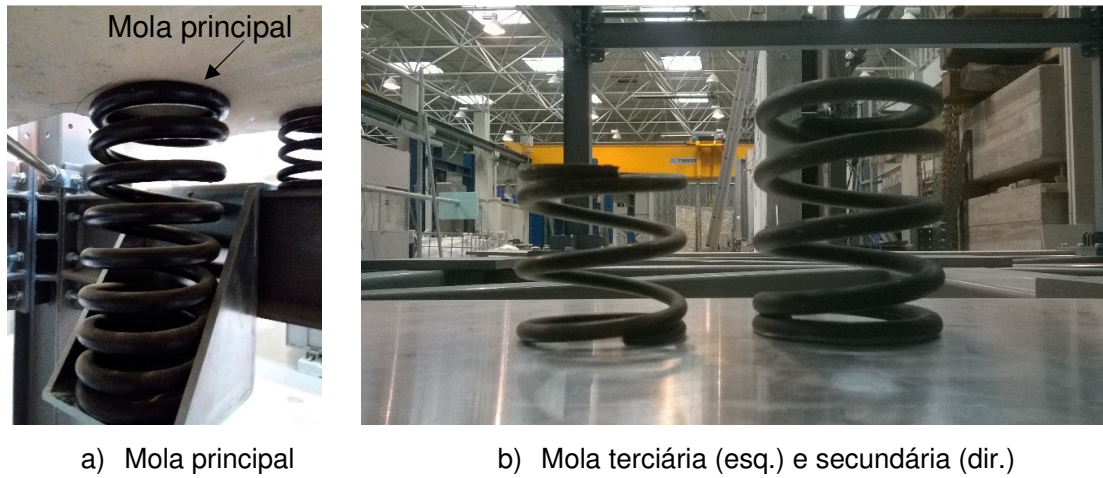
Detalhe das molas de apoio da laje de concreto armado
